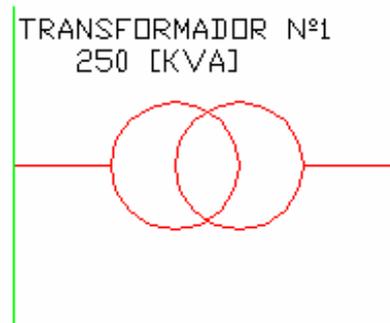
Datos del transformador sobre la pantalla de AutoCAD.
